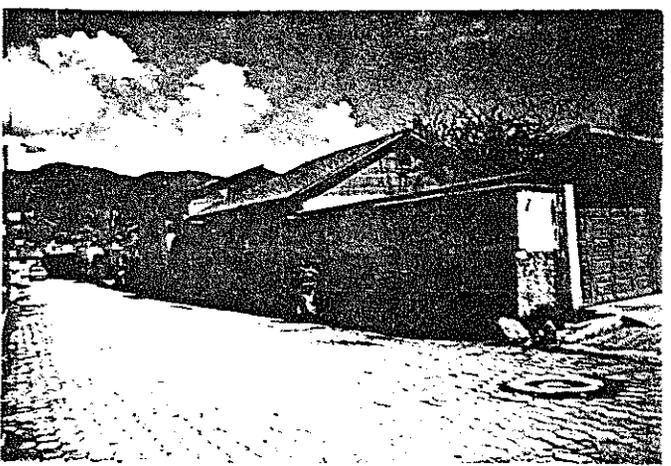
En primer plano se observa una vivienda construida con adobe, techo de lámina de zinc de dos vertiente. Calle adoquinada.
